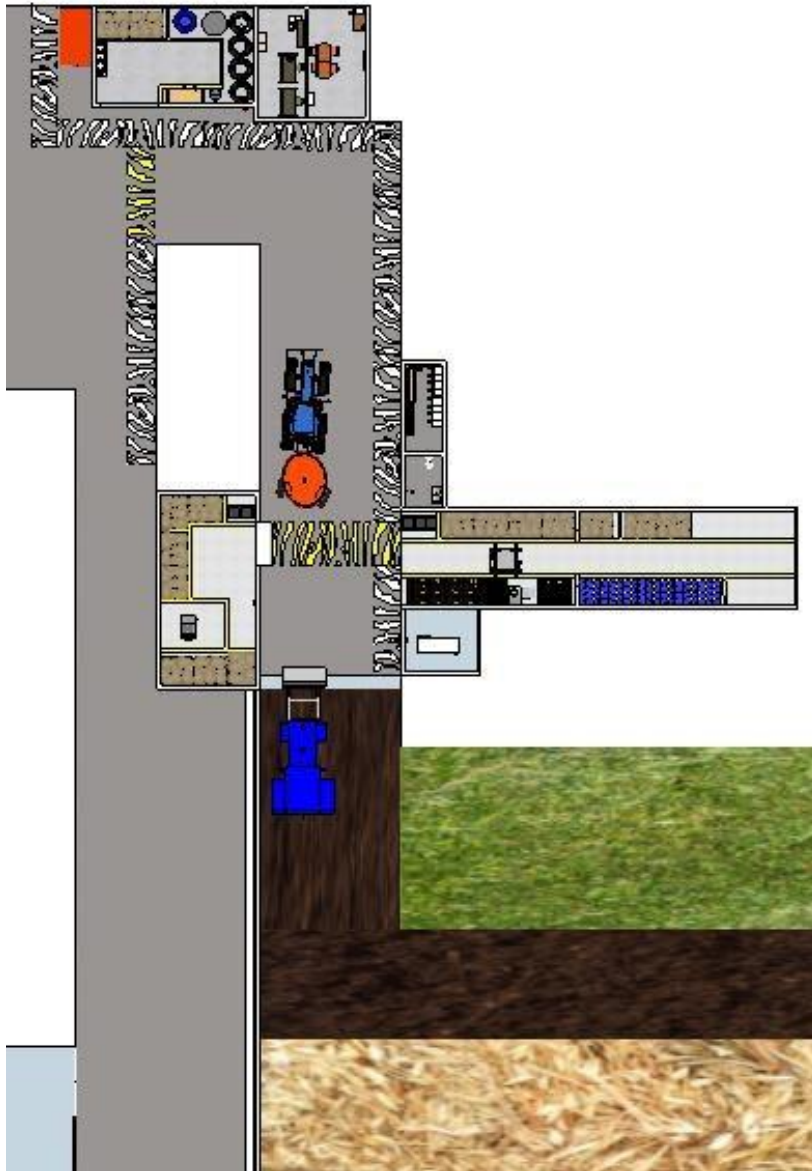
Layout 3D Planta de alimento balanceado para ganado
